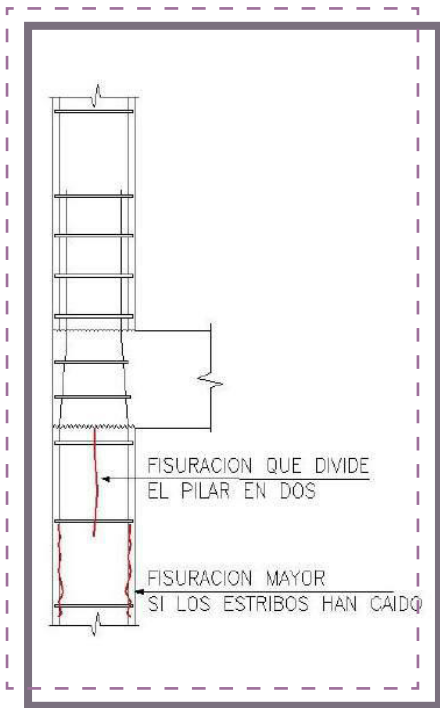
Esquema del aplastamiento por compresión de un pilar.
